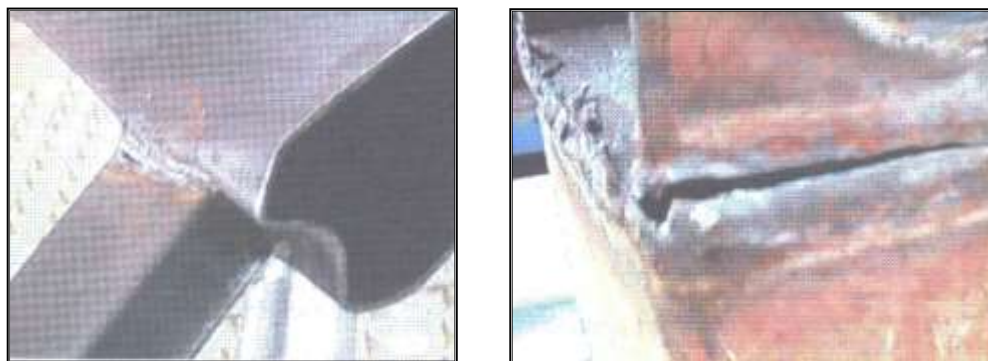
Fallas en ensayos de conexiones directas entre STT.
